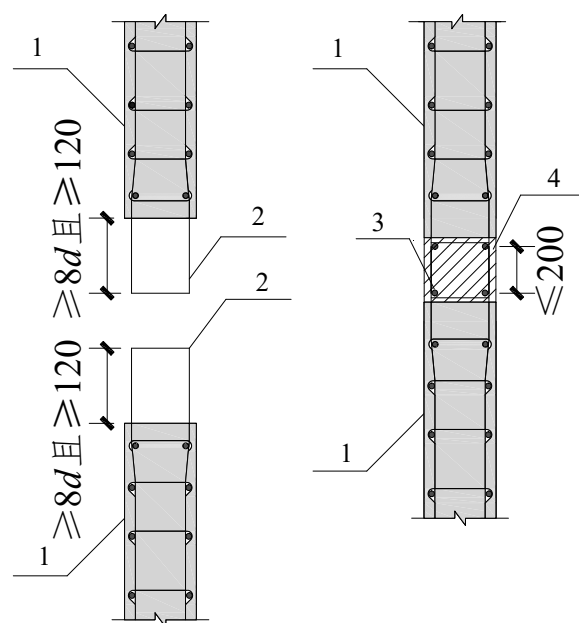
预制混凝土内、外墙环形钢筋扣合连接
